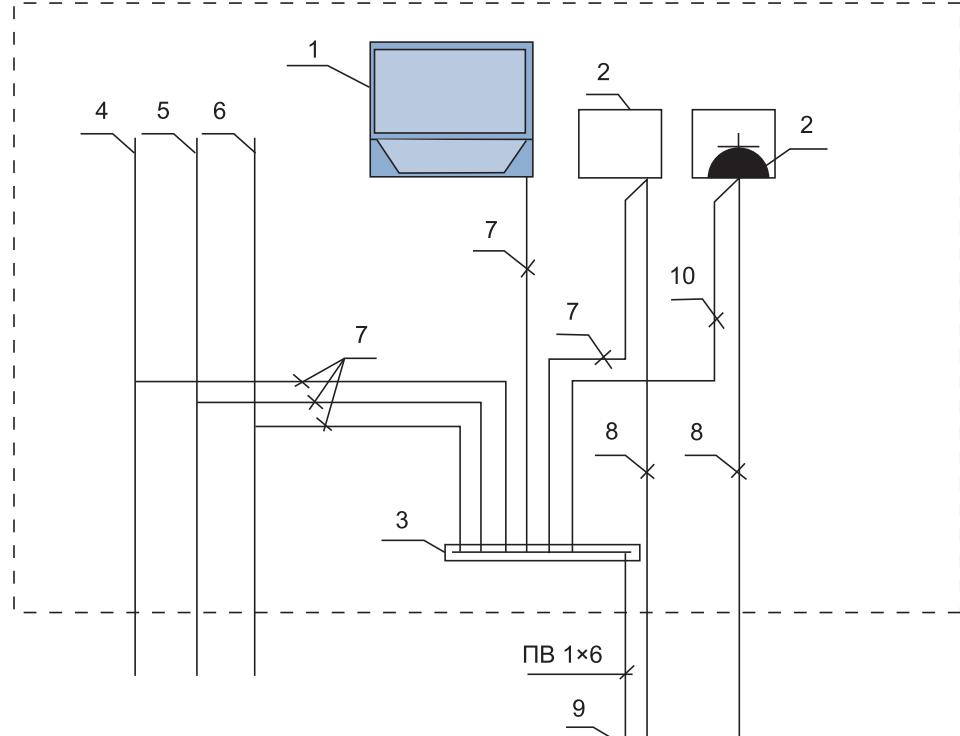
Схема уравнивания потенциалов: 1 — металлический корпус гидромассажной душевой кабины; 2 — заземляемая часть электрооборудования; 3 — коробка с шиной заземления; 4 — металлический стояк водопровода с горячей водой; 5 — металлический стояк водопровода с холодной водой; 6 — металлический стояк отопления; 7 — дополнительные проводники системы уравнивания потенциалов (ПВ 1 × 4); 8 — защитный проводник в составе групповой сети; 9 — ГЗШ; 10 — дополнительные проводники системы уравнивания потенциалов (ПВ 1 × 2,5)
